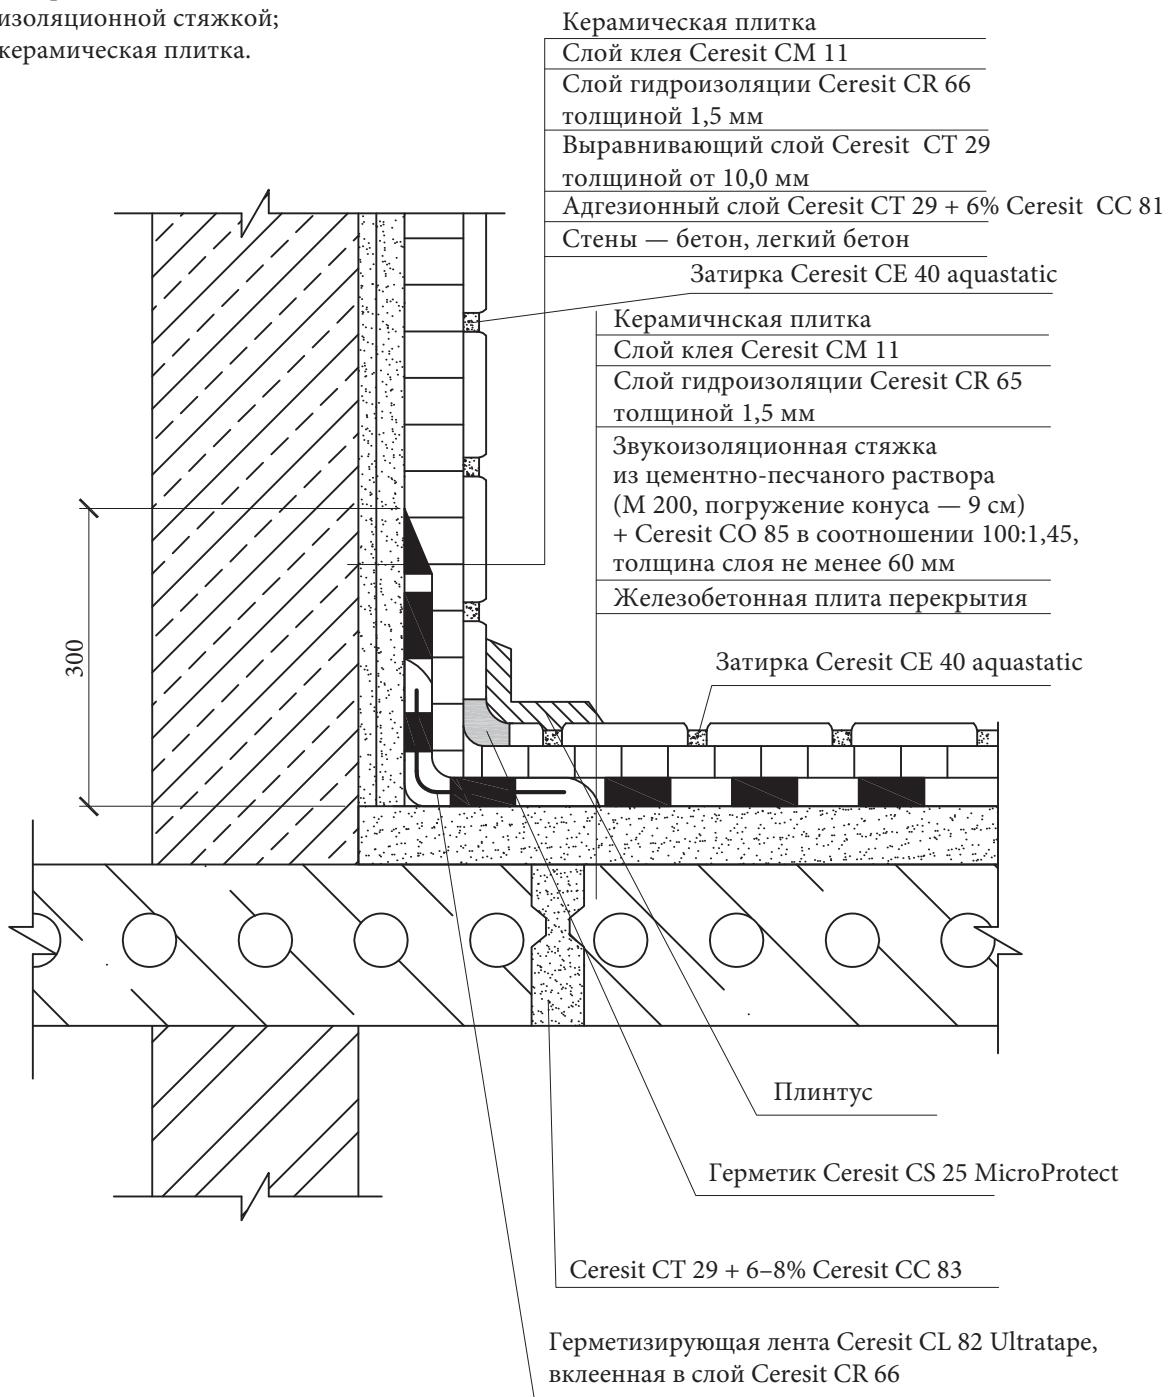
Конструкция системы гидроизоляции бытовых душевых, ванных комнат, санузлов, прачечных помещений, кухонь (стяжка со звукоизоляционным эффектом по пустотным плитам перекрытия)
